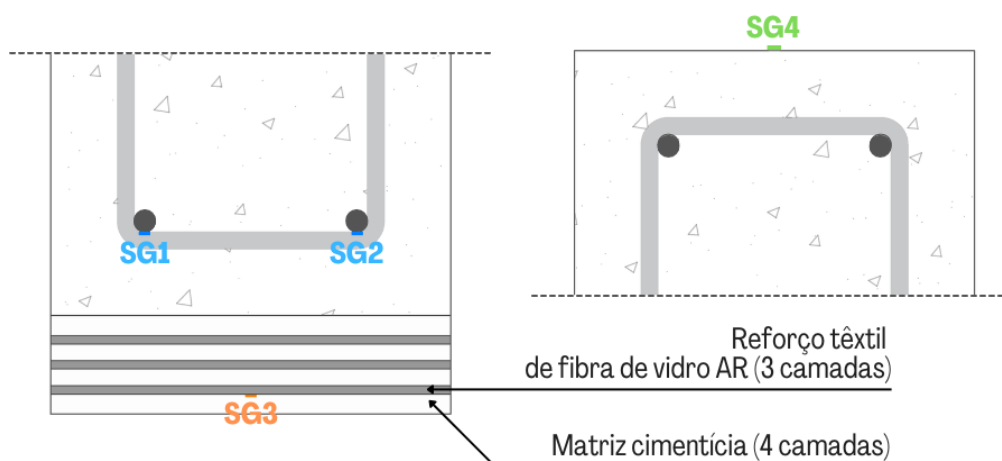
Disposição dos extensômetros (Fonte: Autor)
